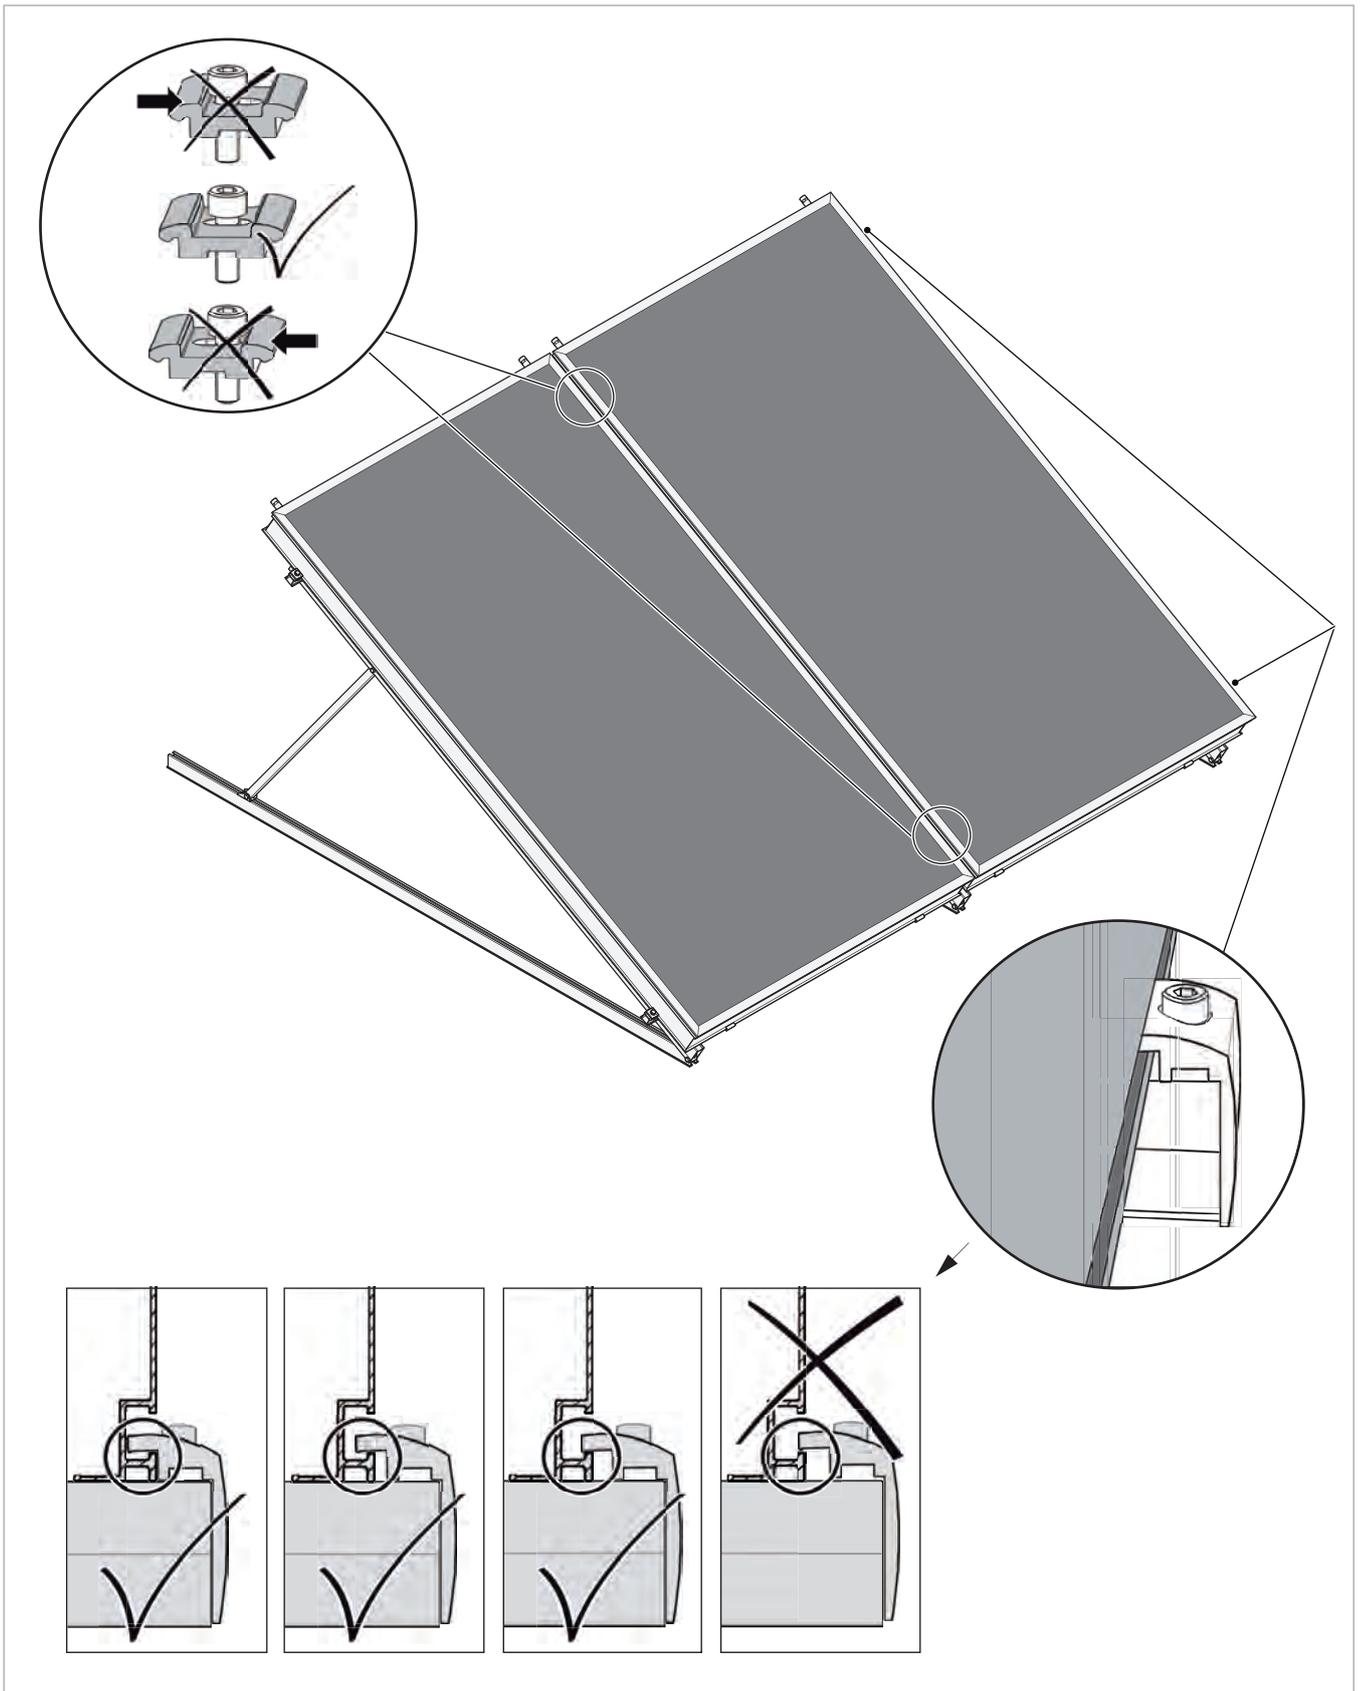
fissaggio dei dispositivi di bloccaggio dei bordi e centrali
